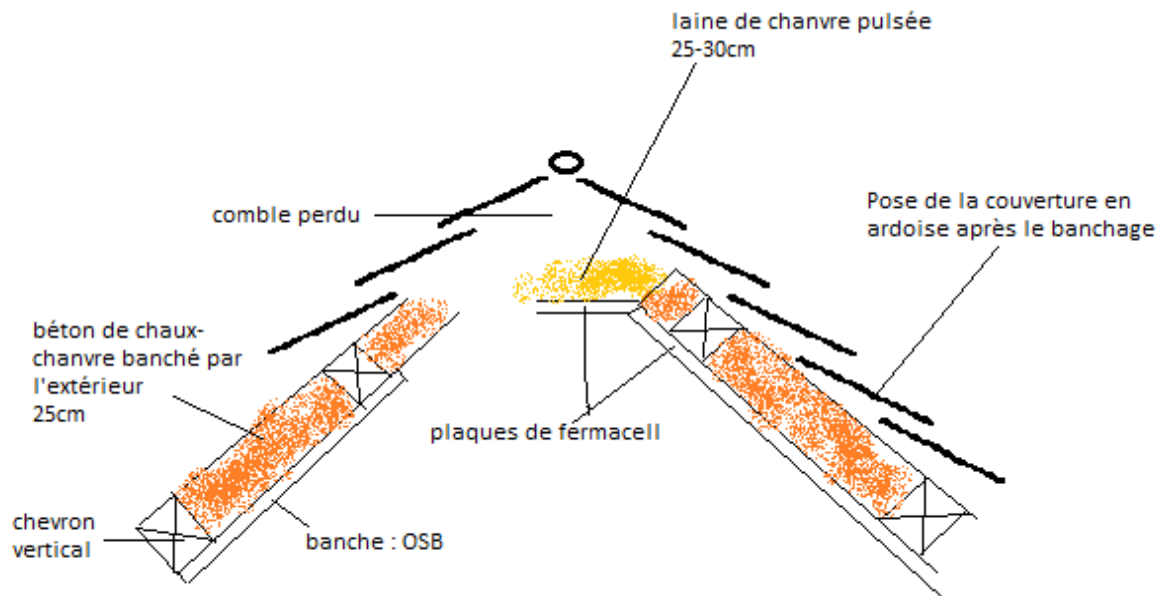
Coupe verticale de l'isolation de la toiture
